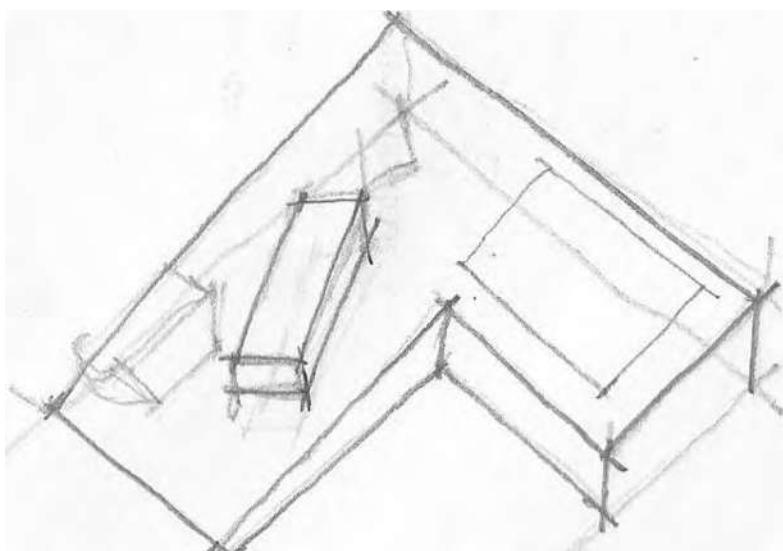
Primera imagen del proyecto. Elaboración propia.
